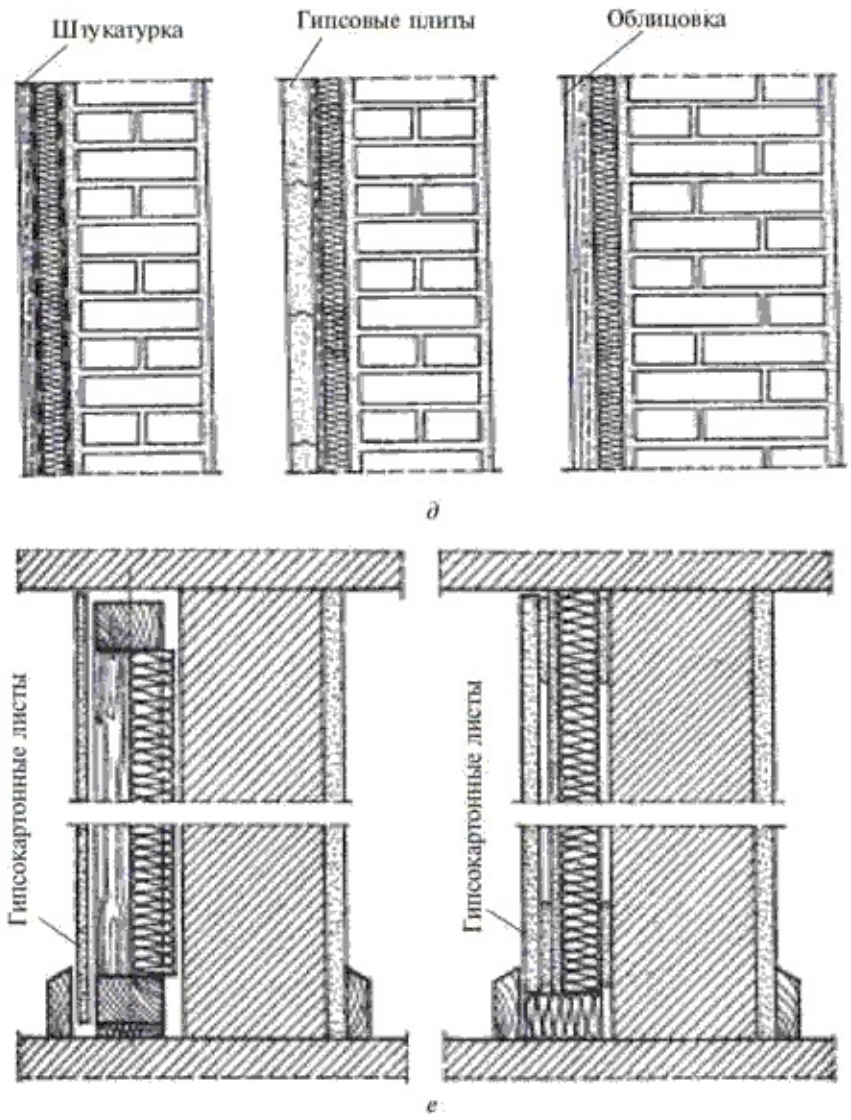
(продолжение). Устройство теплоизоляции на внутренней стороне стены и внутри каменной кладки:
